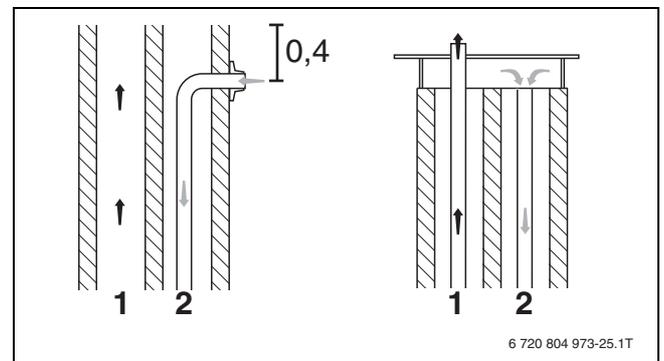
Exemples de construction d'ouvertures (dimensions en m)
